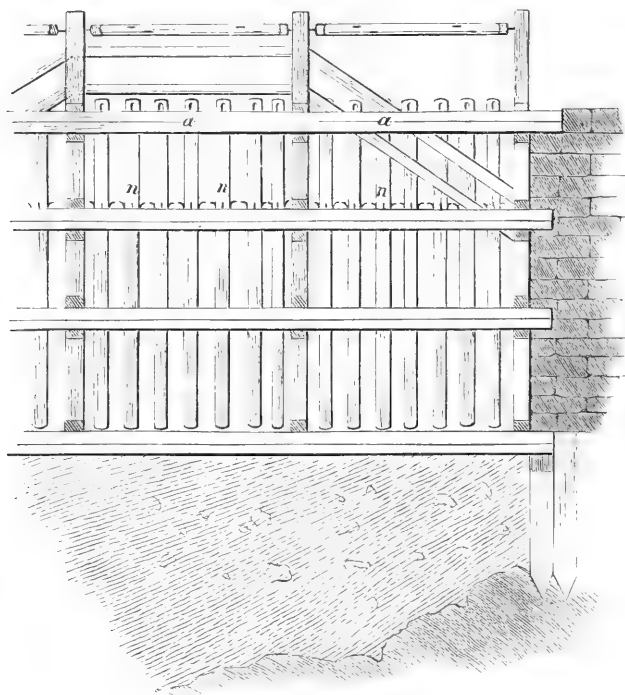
Rechen mit aufziehbaren Spindeln für Sägemühlen.
